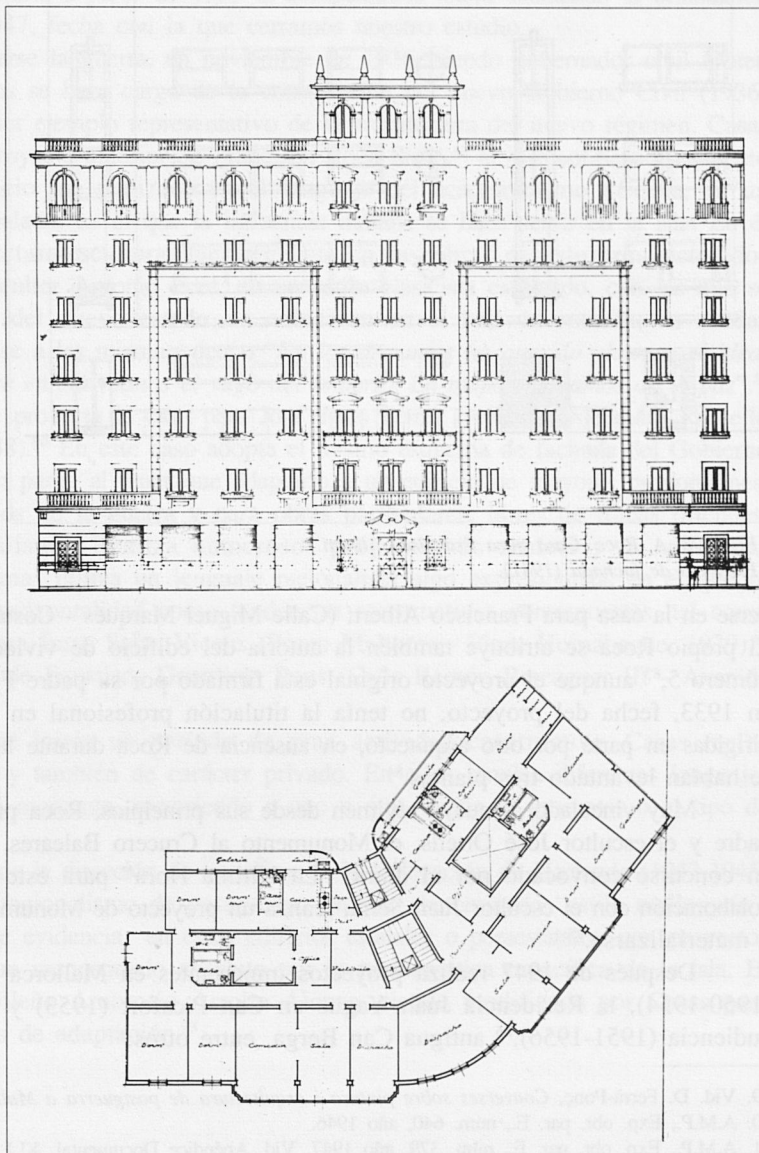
Antonio Roca. Casa para Jaime Jaume. Proyecto de fachada y planta (1946).
